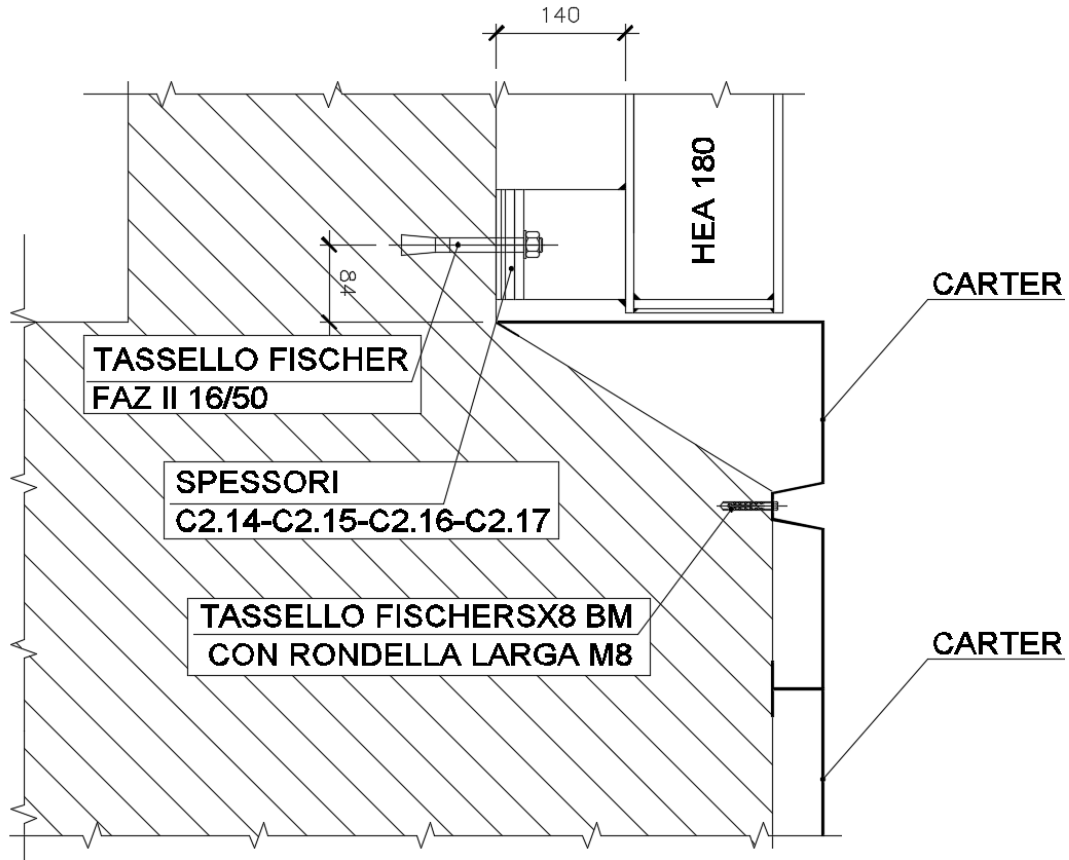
Dettaglio del collegamento HEA180 basso della barriera lato ferrovia
